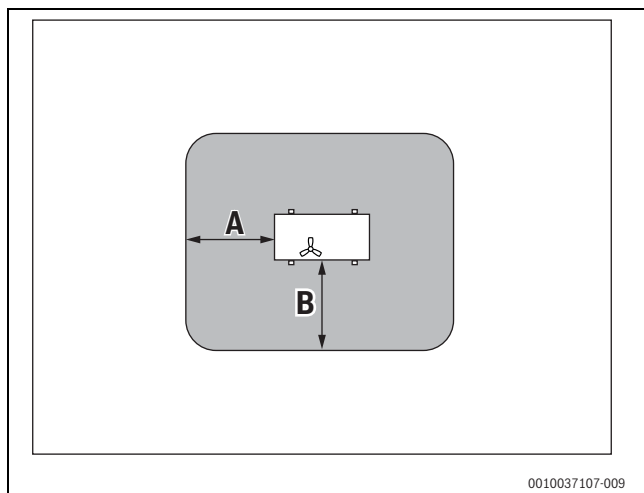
Sicherheitsbereich bei Bodenmontage auf Grundstück oder Dach
